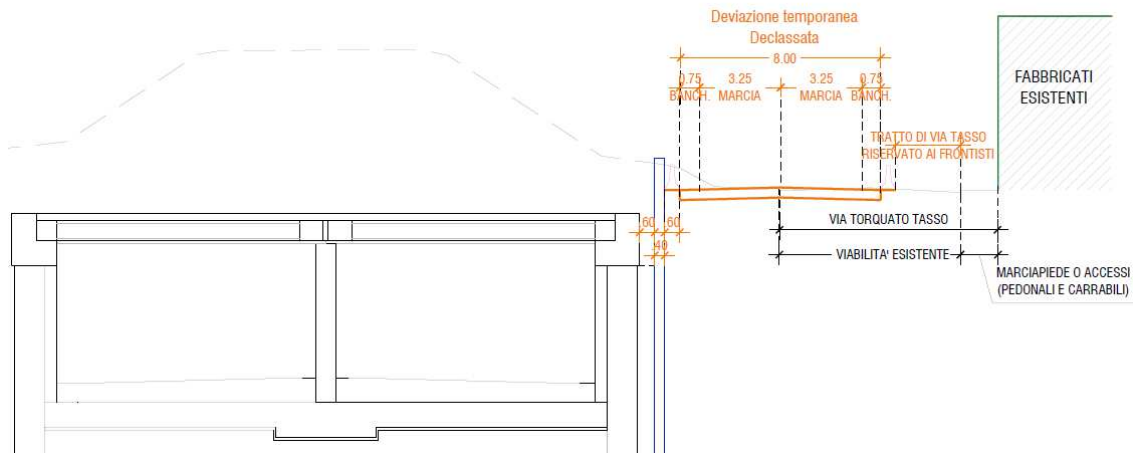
Sezione deviazione provvisoria Fase 3 (esterna alla galleria artificiale)
